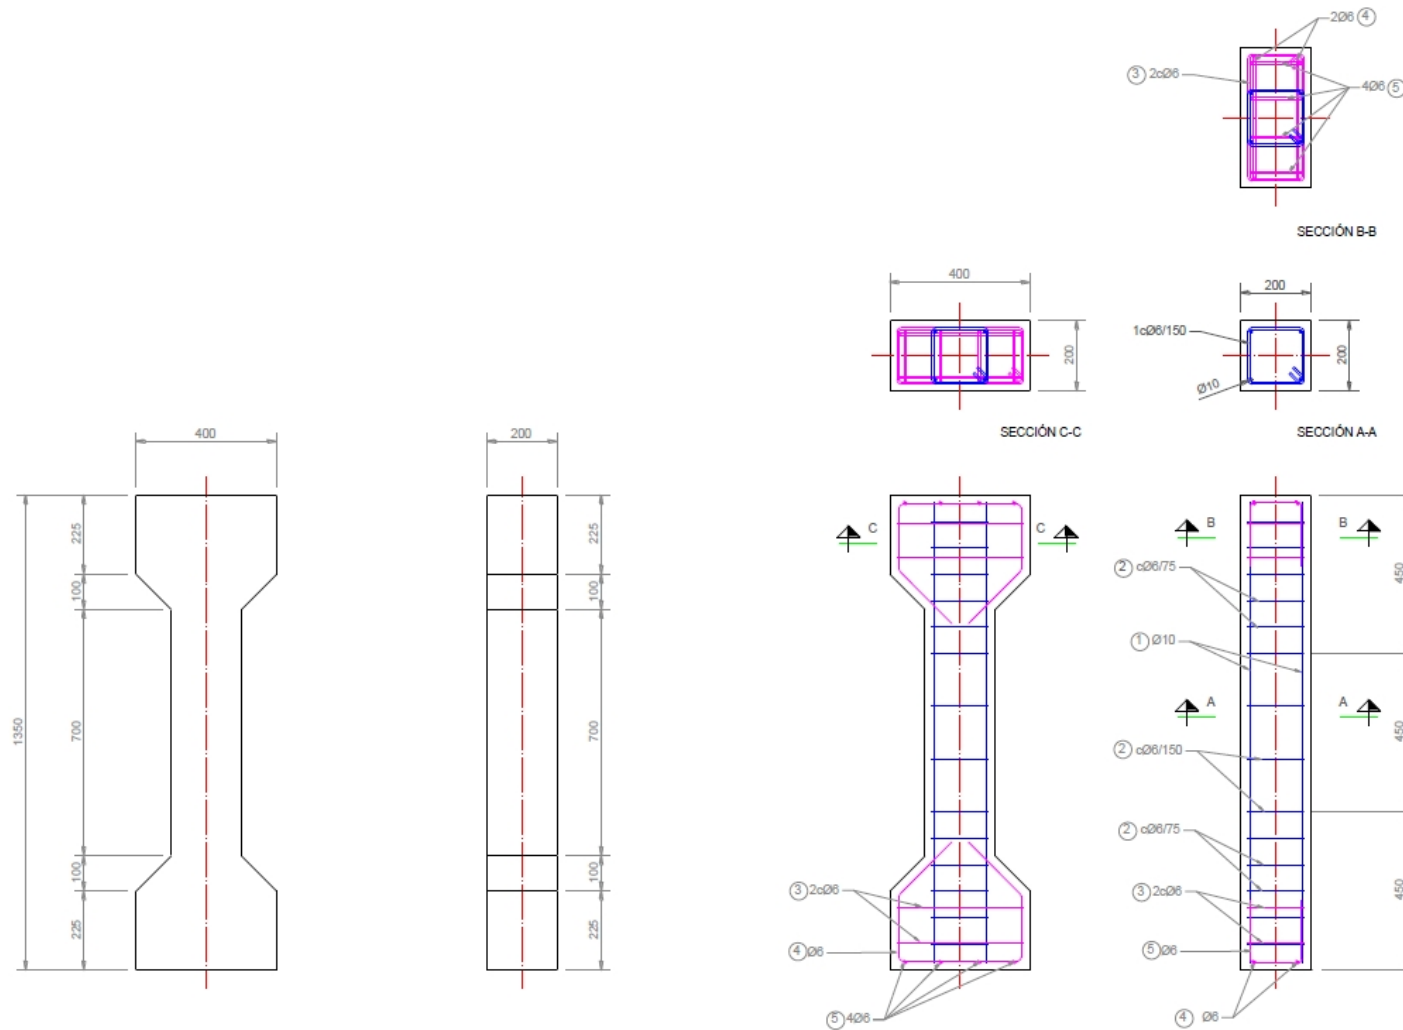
Detalles de la geometría y armado de los pilares previos.
